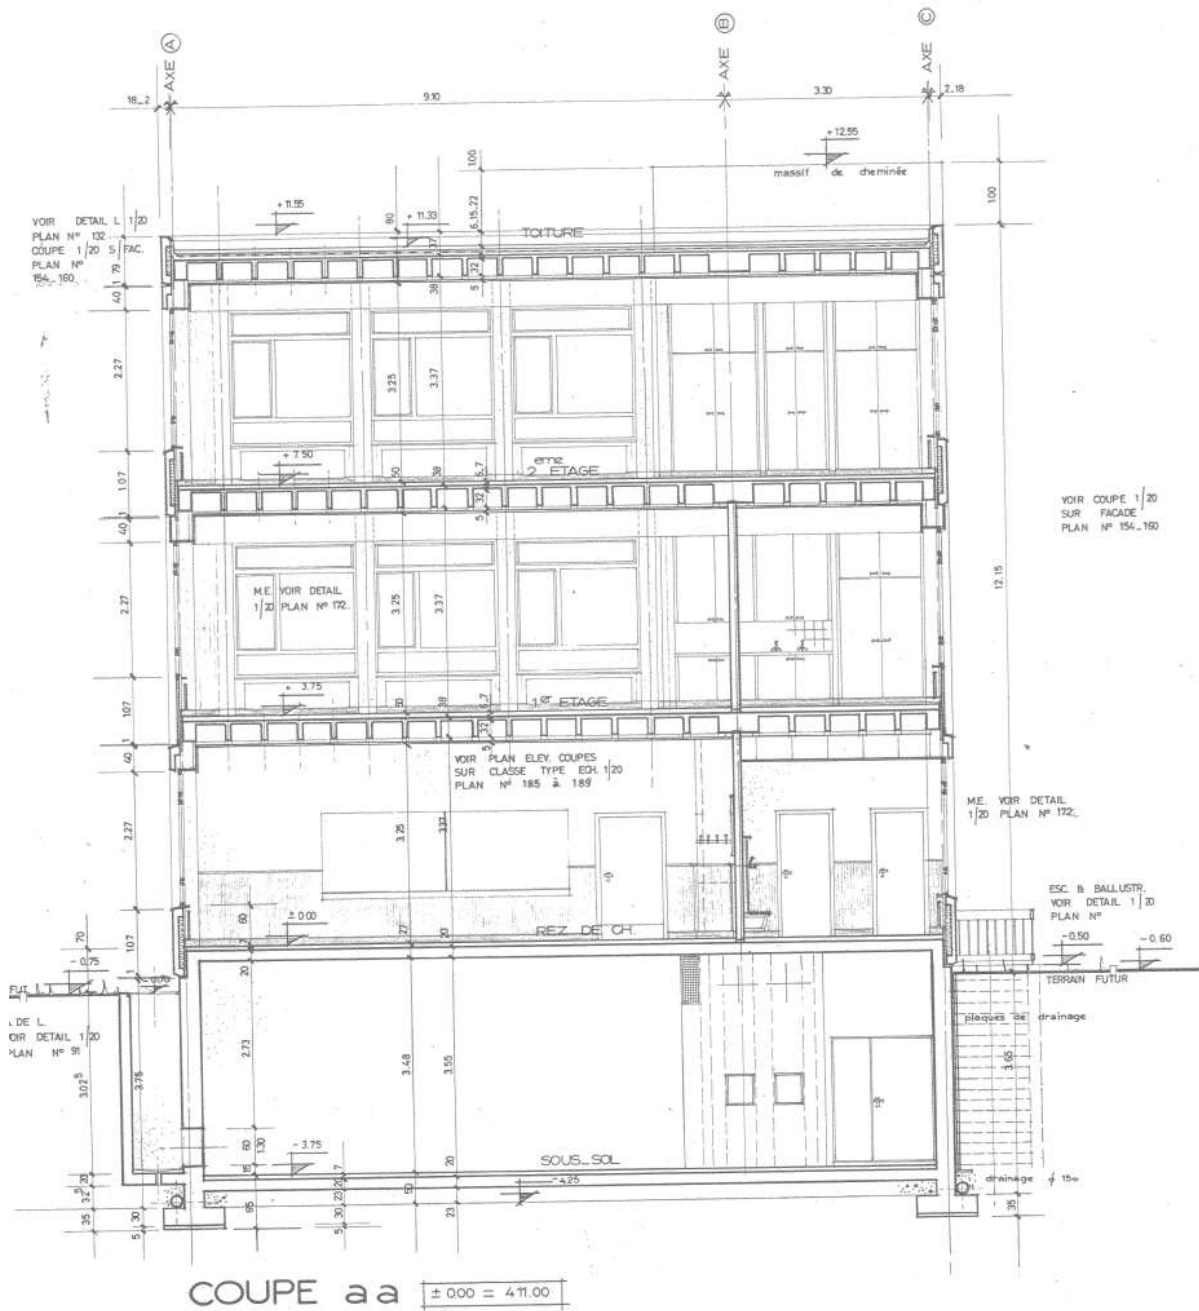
Aile Ouest, extrait du plan num. 133
